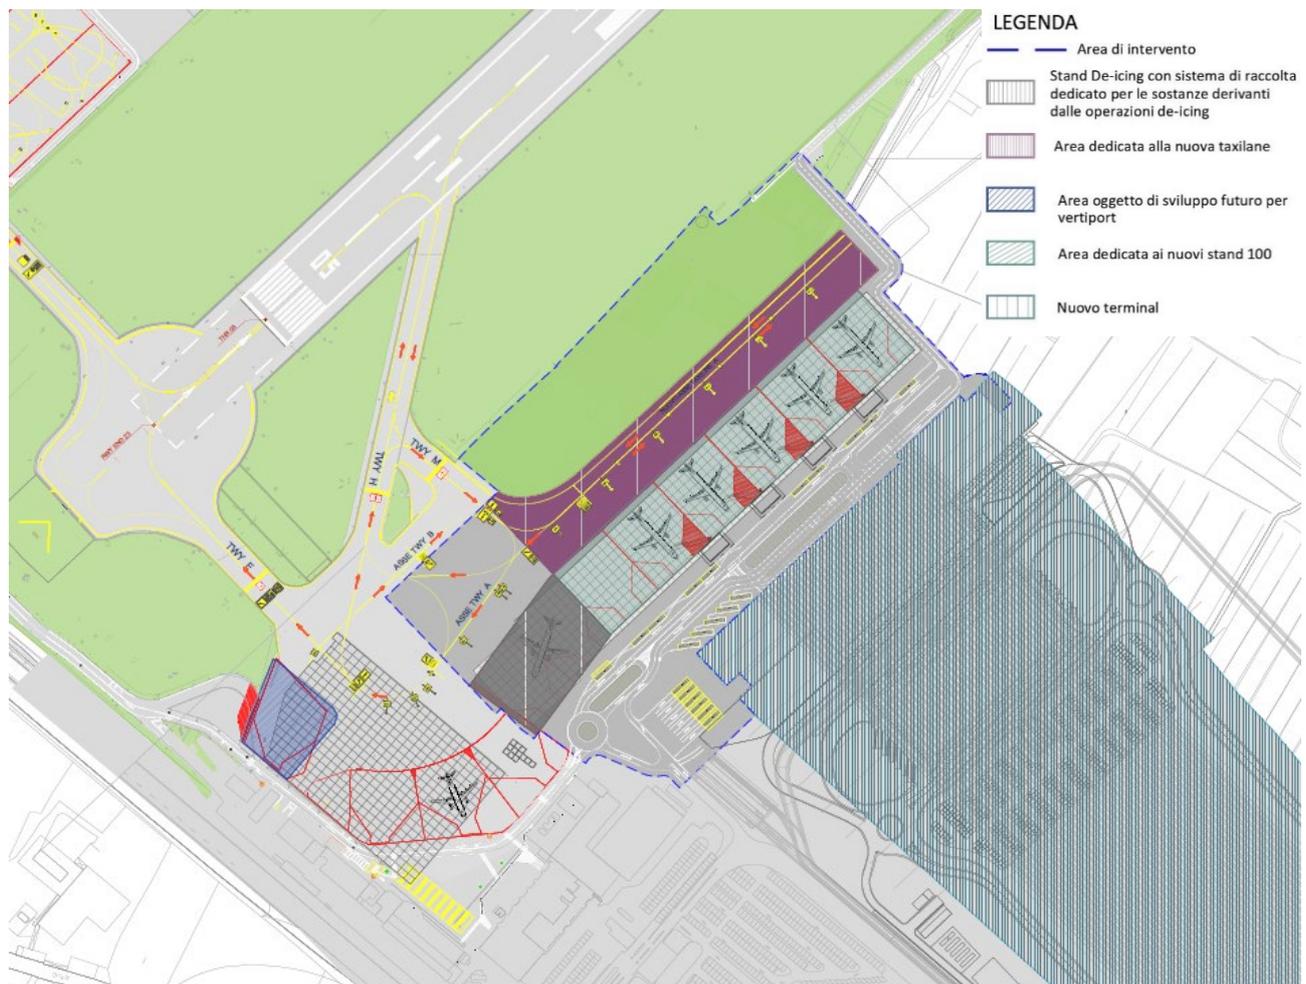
Planimetria di caratterizzazione funzionale delle aree di intervento.
